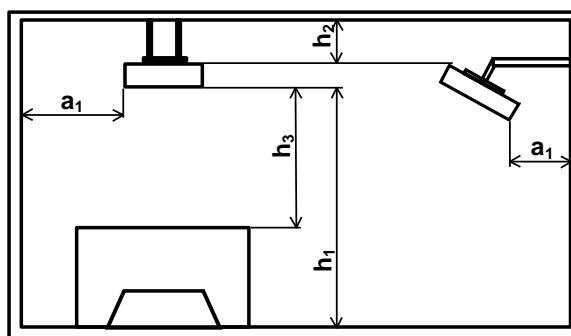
Габаритные и присоединительные размеры излучателя
